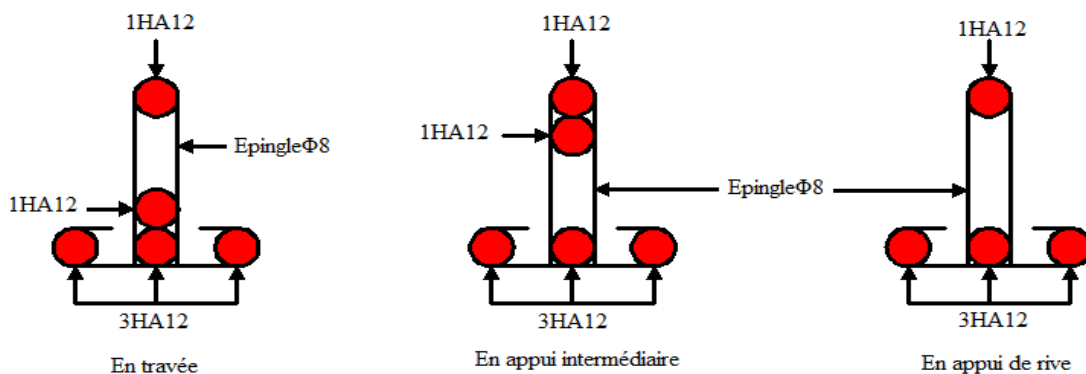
Schéma de ferrailage des poutrelles Terrasse inaccessible
